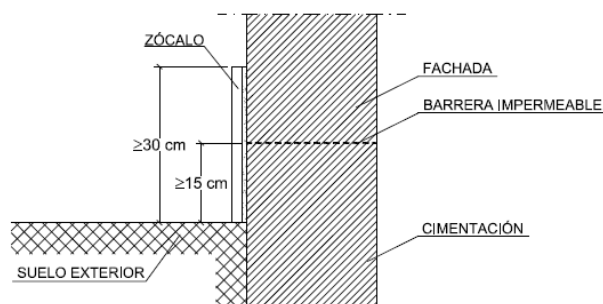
Ejemplo de arranque de la fachada desde la cimentación
